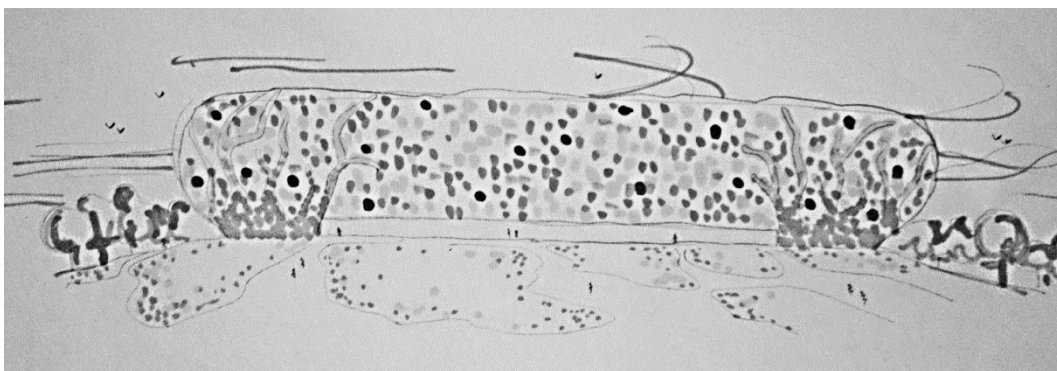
Boceto de fachada para estadio, sin escala.
